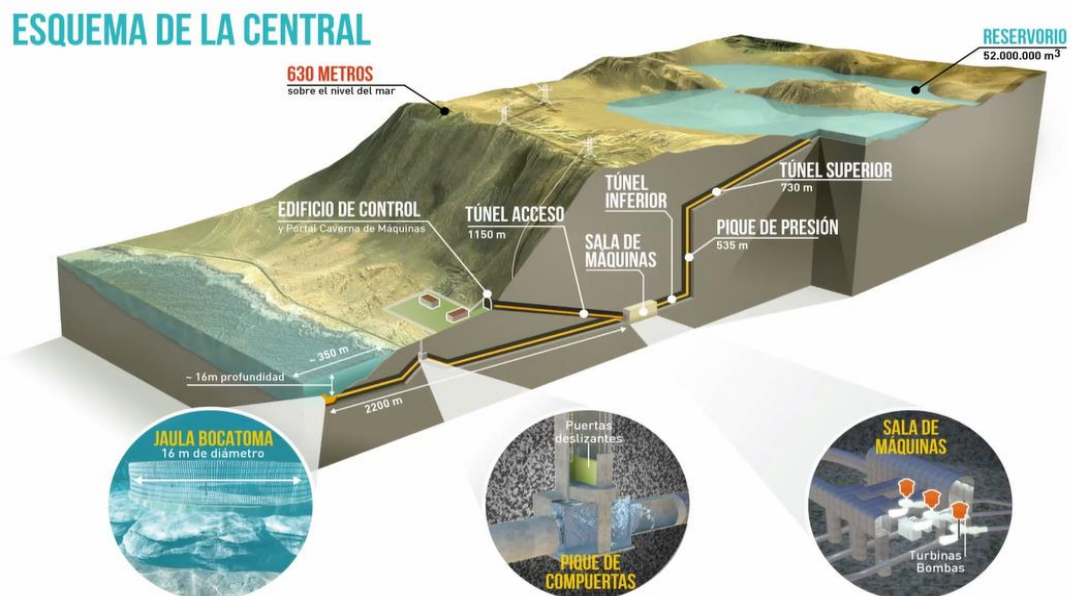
Esquema del proyecto Valhalla. Fuente: Valhalla.
